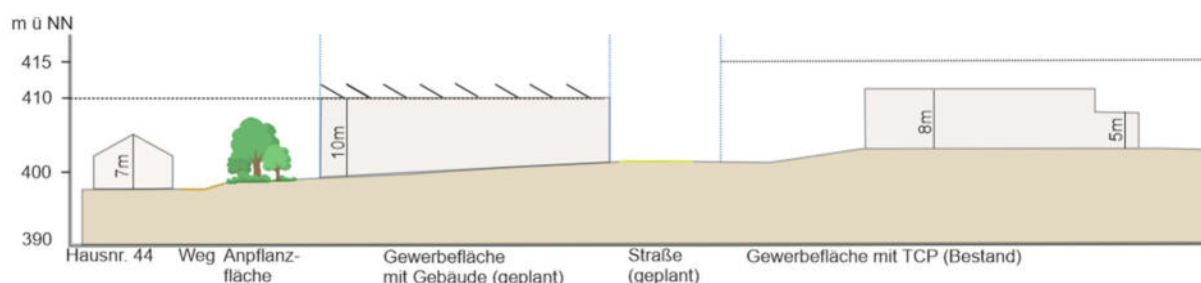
Schnitt C – C', zulässige Gebäudehöhe von 410 m ü. NN (+ 2,00 m Dachaufbauten)
